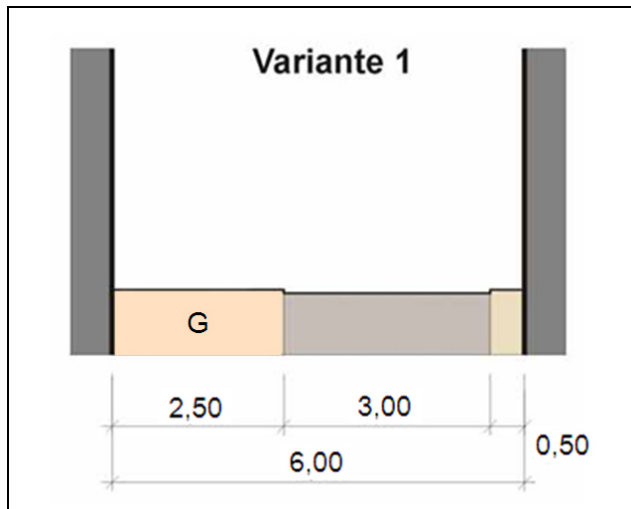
Umbauvariante 1 (Kaltensondheimer Str.)
